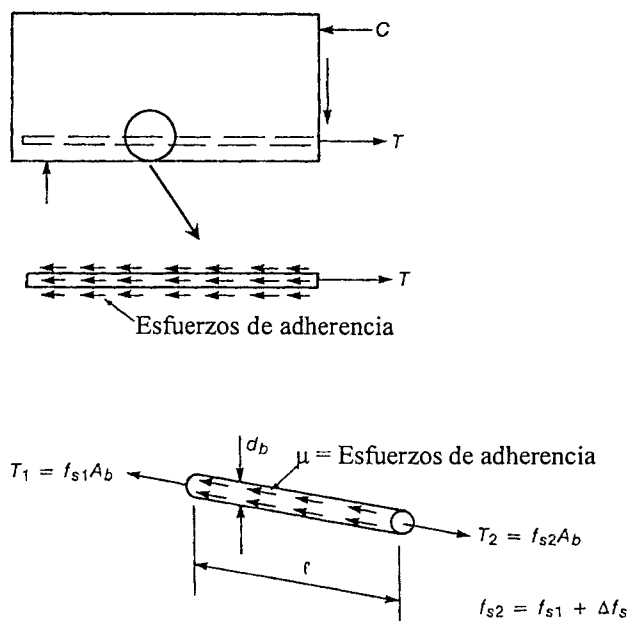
Esfuerzos de adherencia en las barras de refuerzo.
